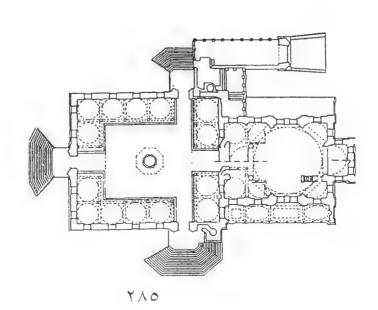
المسقط الأفقي لجامع نور عثمانية .
